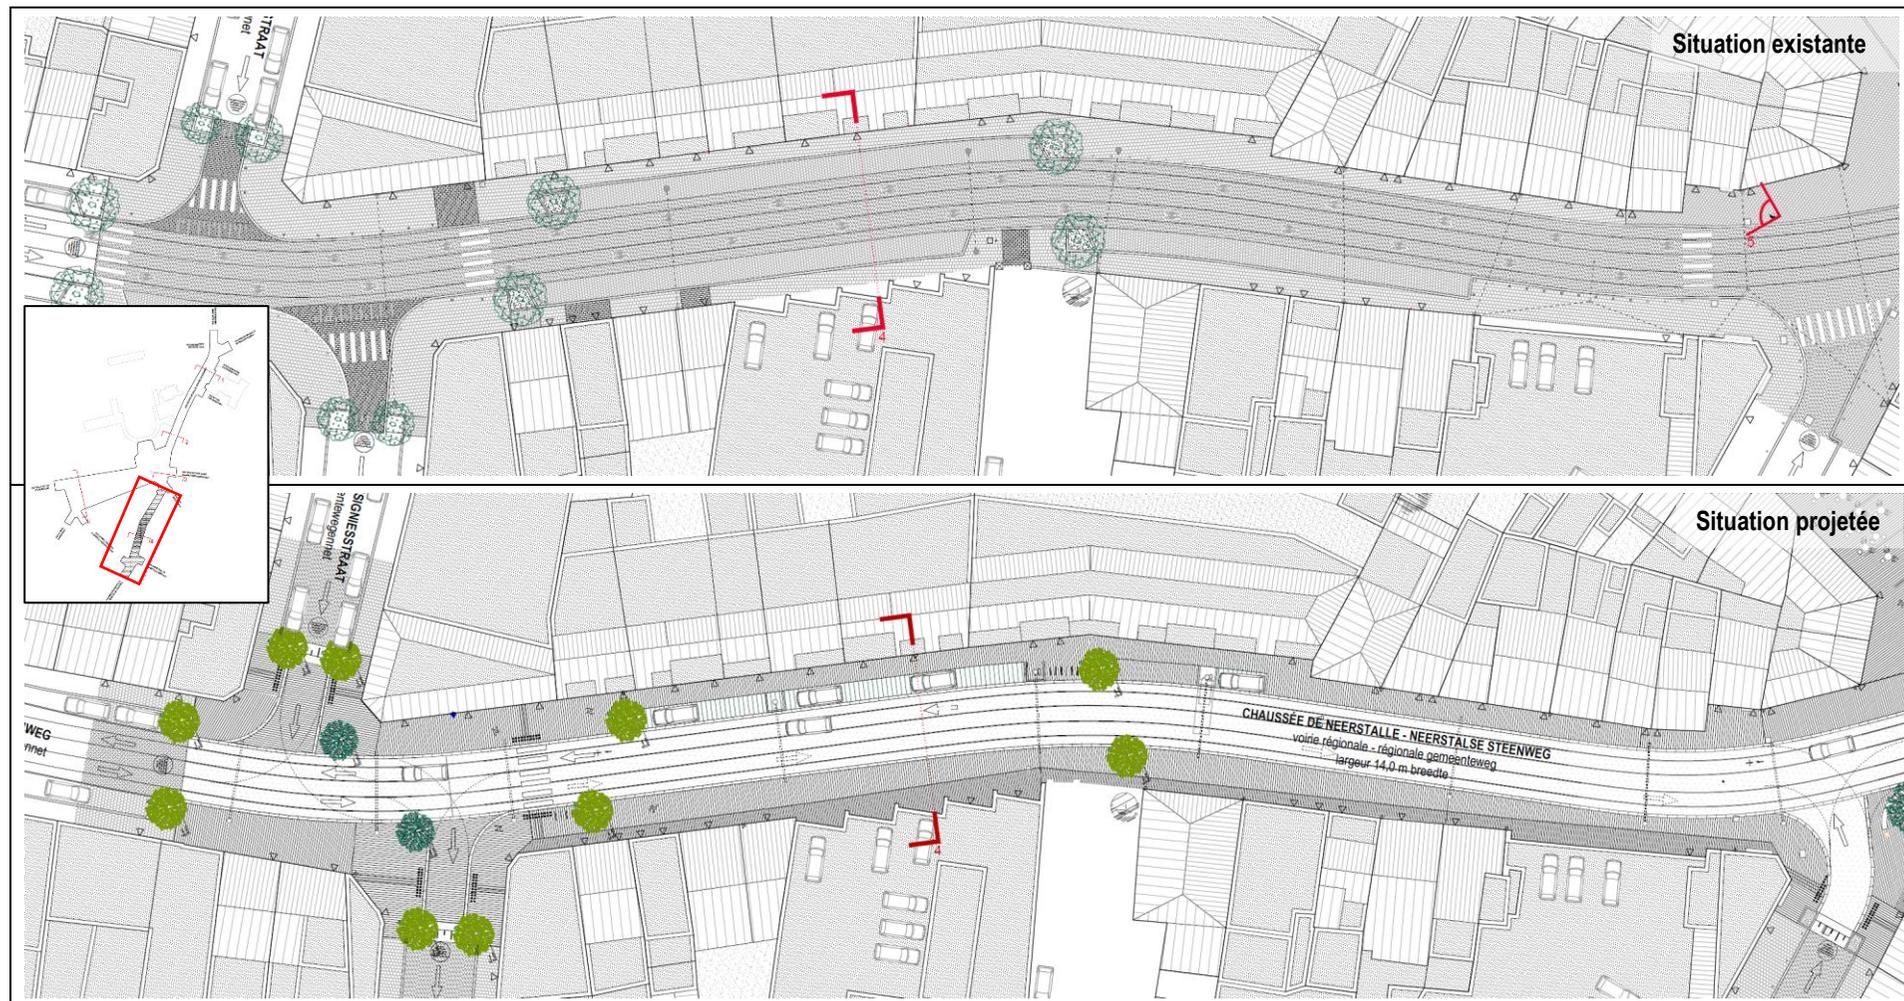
Situation existante et projetée de la chaussée de Neerstalle (A-Practice, 2021)
